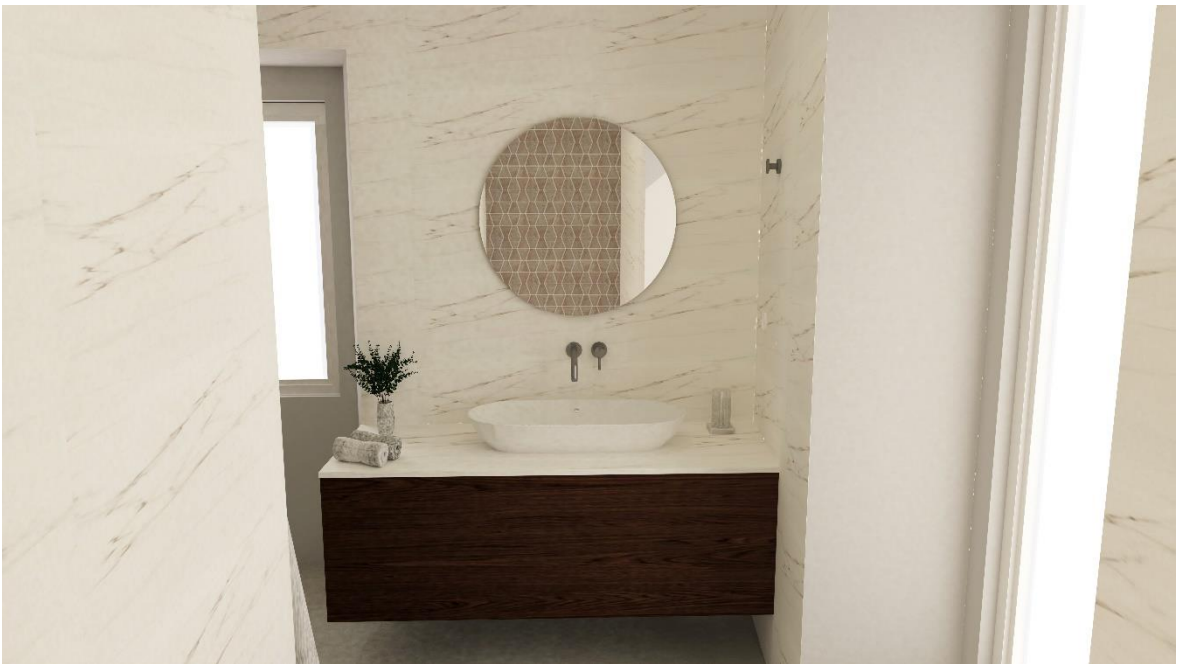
Visualização 3D - instalação sanitária, suite (vista 1)
